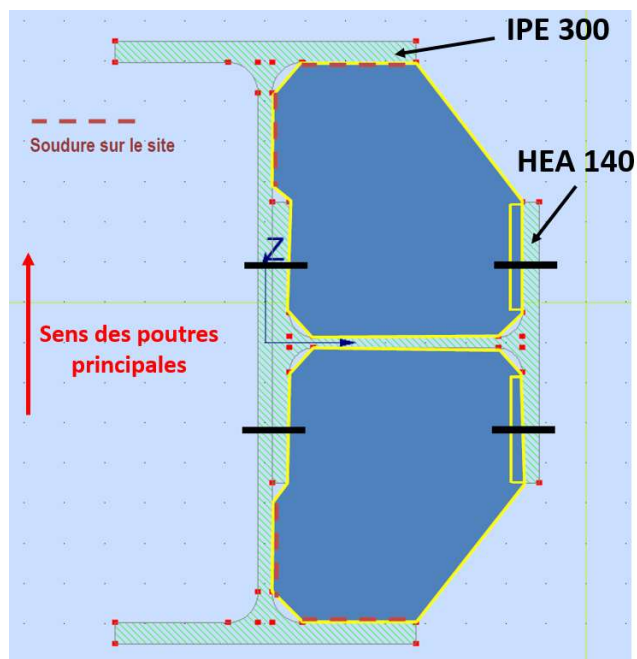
Détail du poteau IPE 300 renforcé d'un HEA 140
